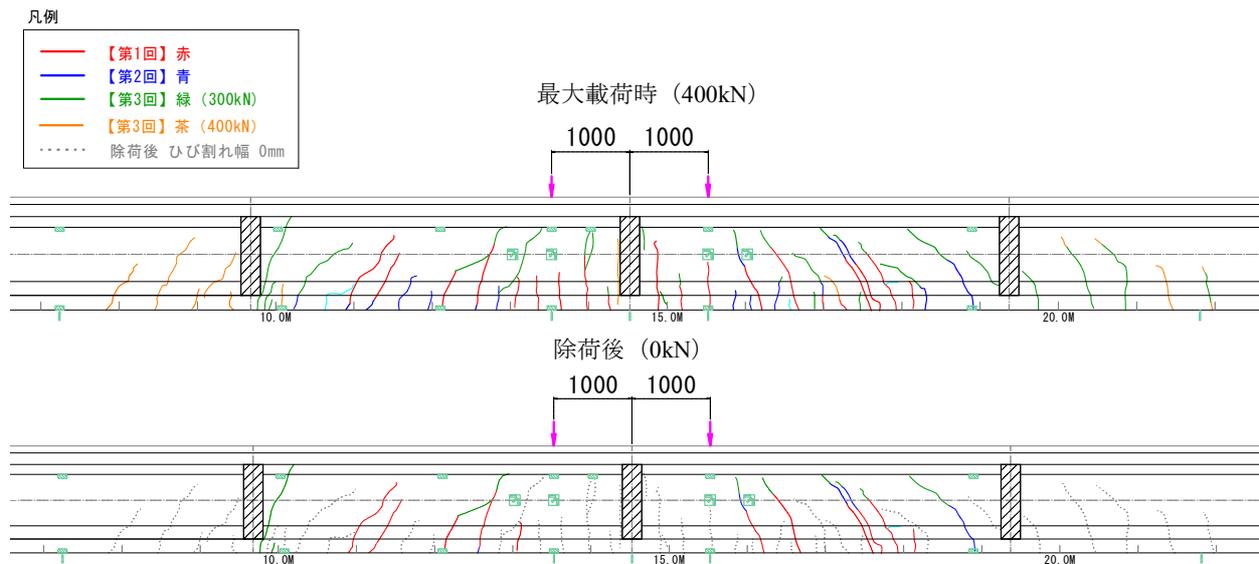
各載荷荷重状態でのひび割れ発生状況
